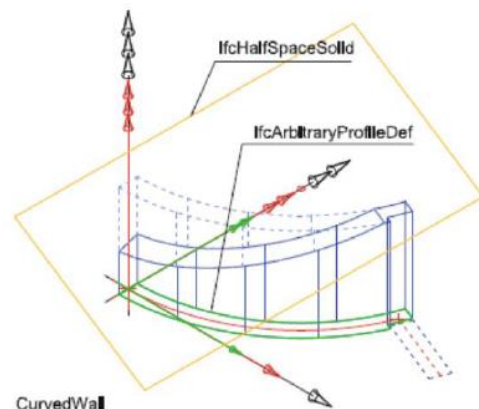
prozedurale Geometriebeschreibung einer gebogenen, abgeschnittenen Wand [1]
